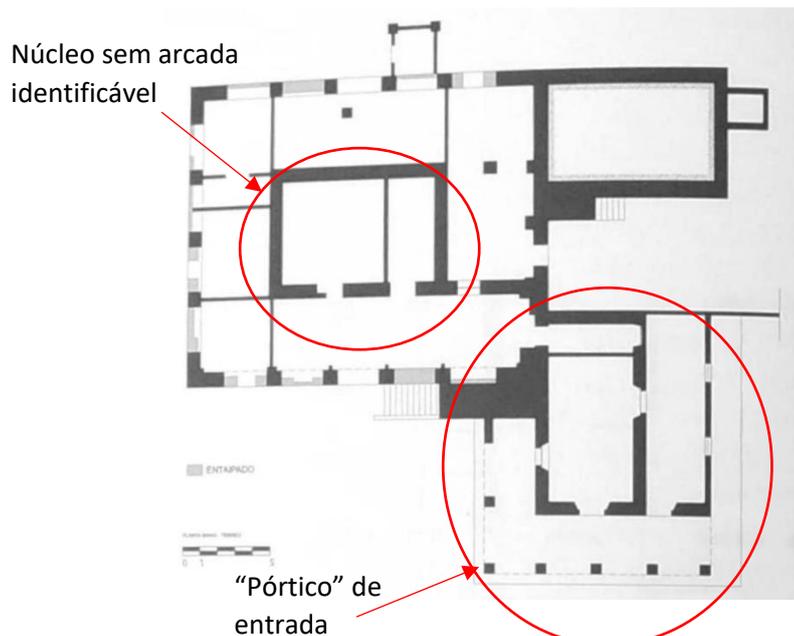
Planta do pavimento térreo da casa do Engenho Gurjaú.
